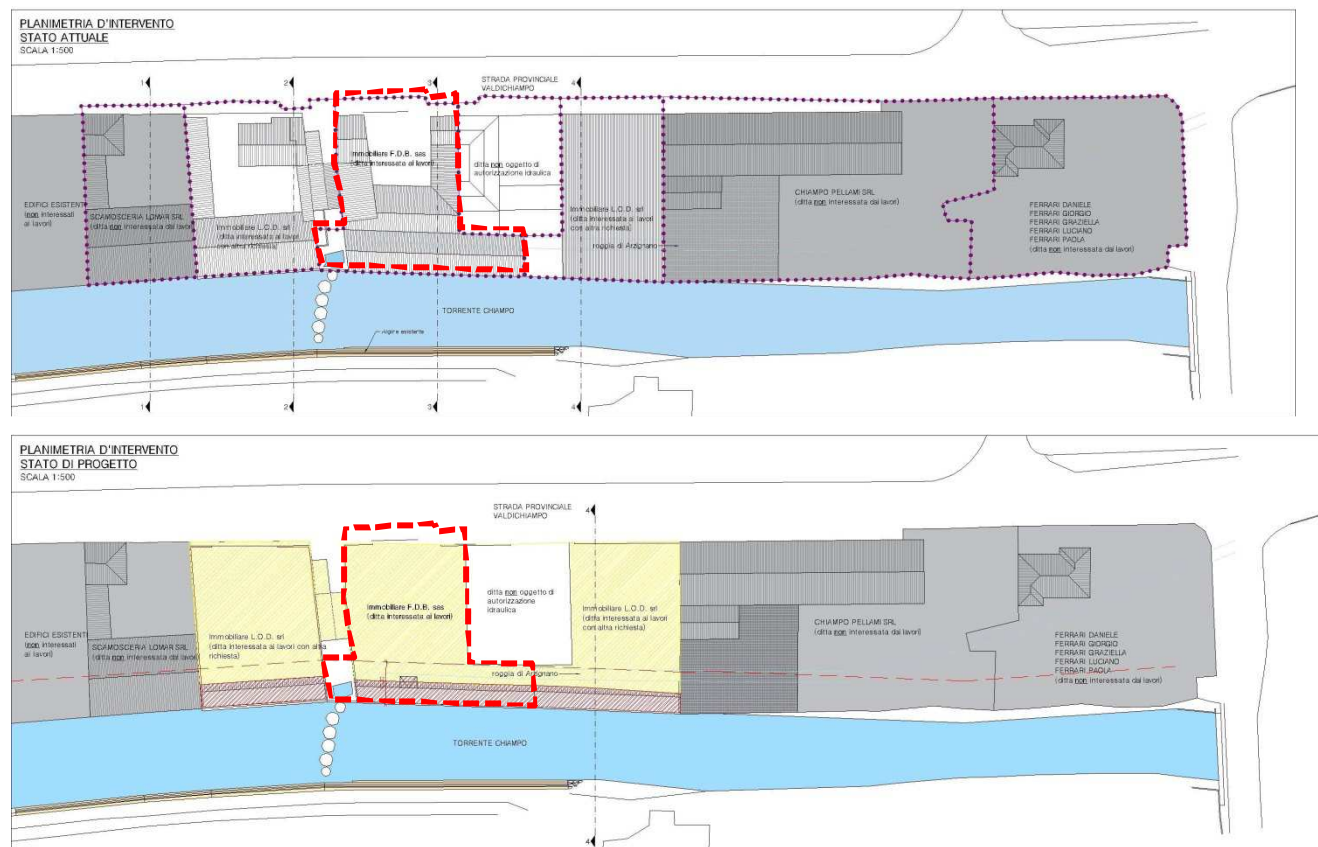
Estratto TAV 4 Piante di progetto di “Riempimento a sostegno del muro attualmente in precarie condizioni in attesa di un rifacimento futuro (Arch. Forti, 28.04.2016)”; in rosso area di interesse
